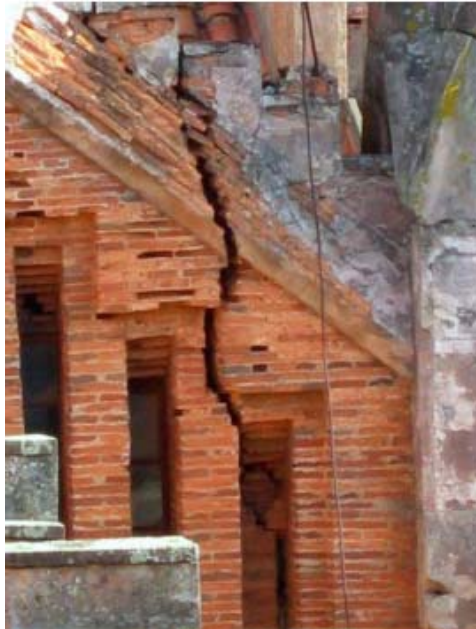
Agrietamiento importante (apertura de 6 cm) en un muro de arriostramiento de un edificio del siglo XIX.
